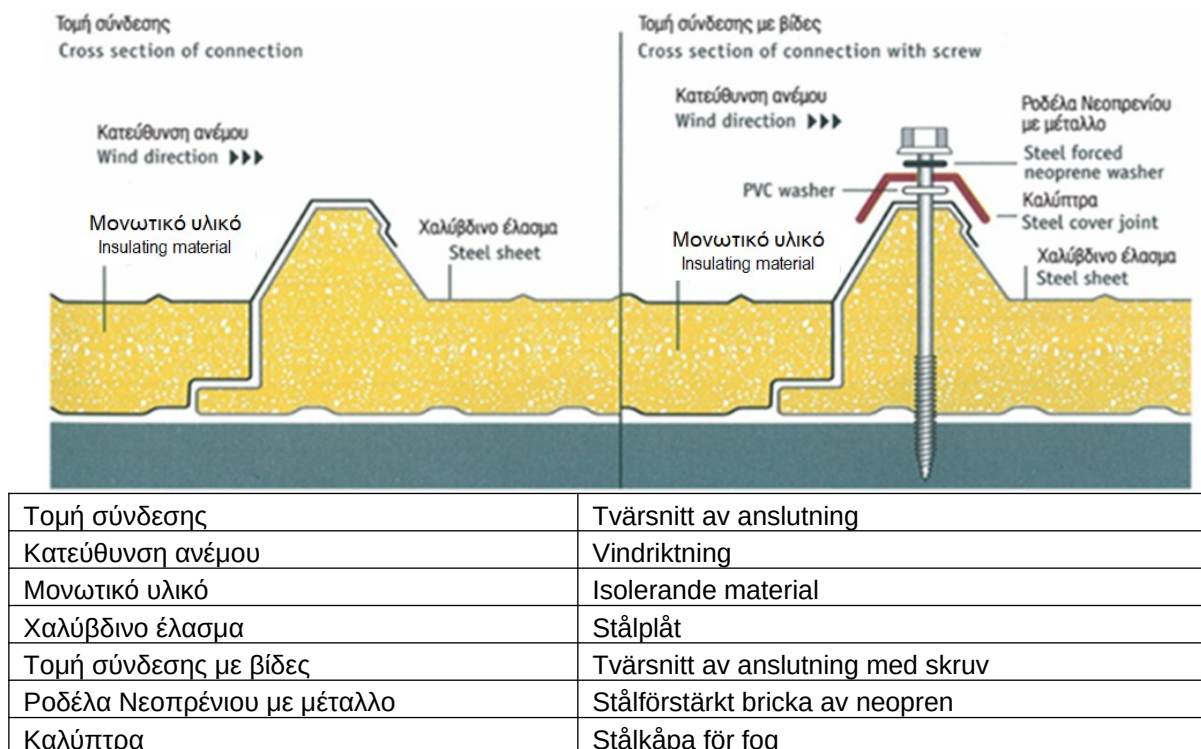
Installation av paneler och fastsättning av dem i F.O.
